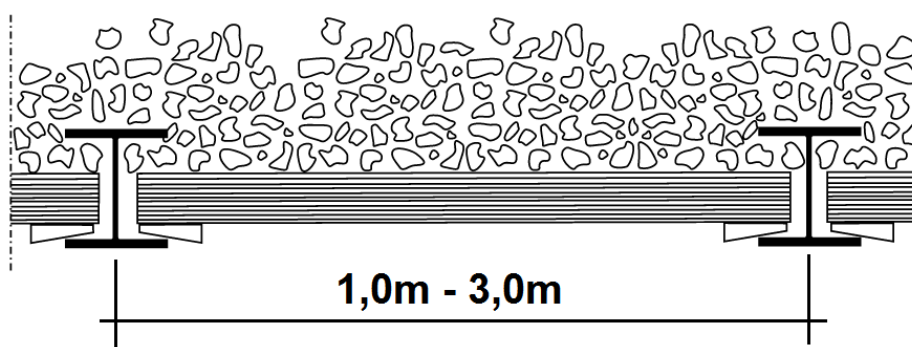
Corte transversal de uma cortina do tipo perfil pranchado.
